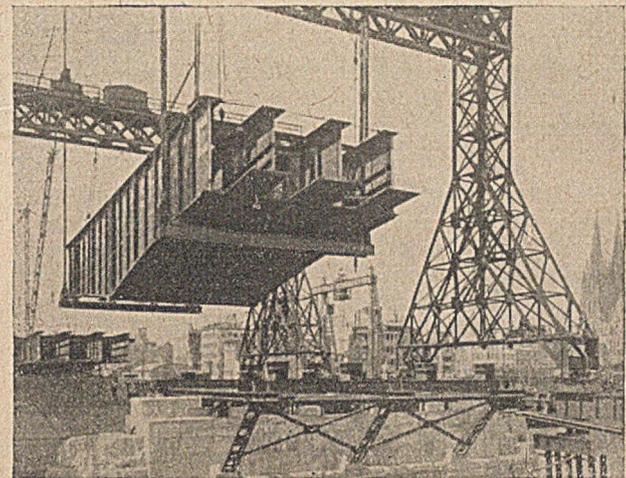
Einbau des rechten Pfeilerstückes mittels zweier Hubportale (4. 5. 1948).
